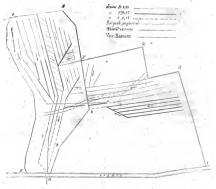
Plan de drainage d'une pièce de terre située sur la commune de Chabris (Indre).
